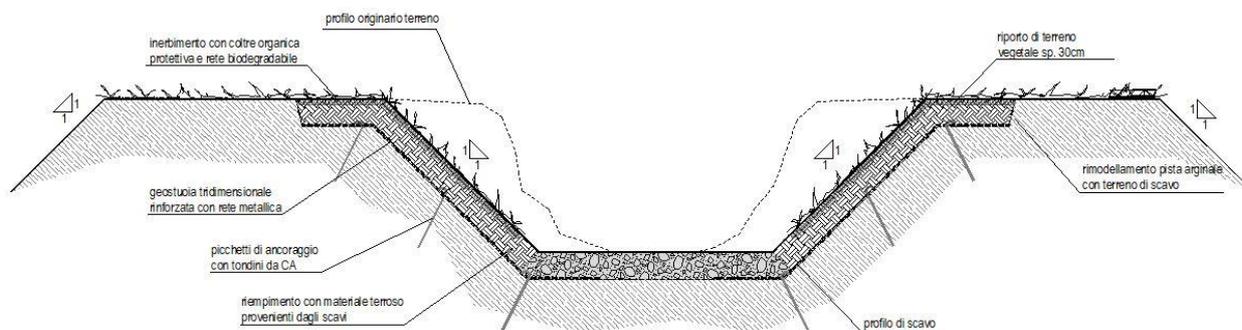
INTERVENTO DI PROGETTO, SEZIONE TIPOLOGICA 2 "CANALE INERBITO"
